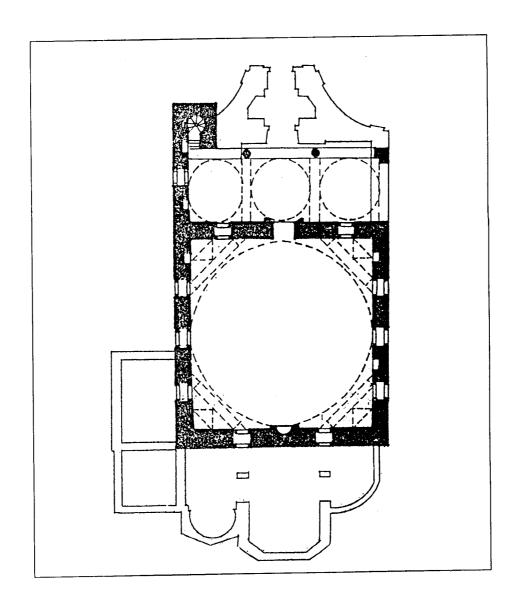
مسقط أفقي لمسجد تاتار (تتر) سنان بك في Cumanovo (عن : كيل) .
